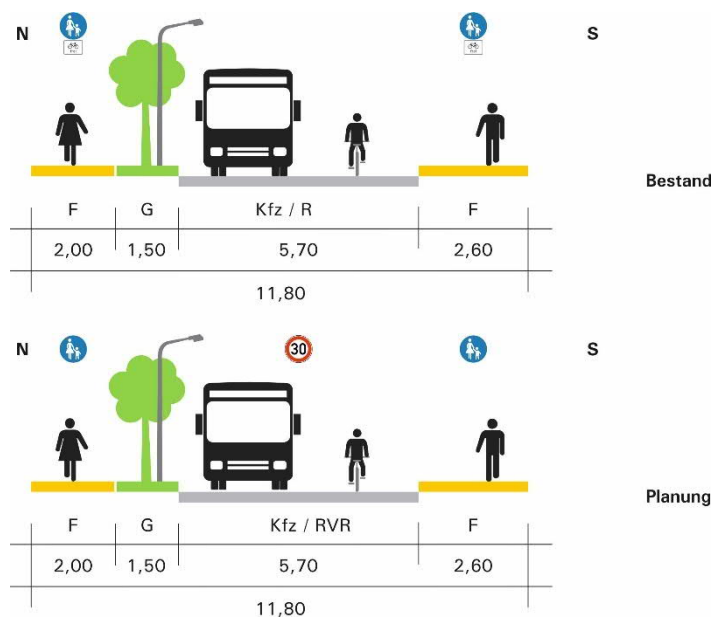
Querschnitt Abschnitt Claus-Ferck-Straße (A-06; Bestand und Planung)
